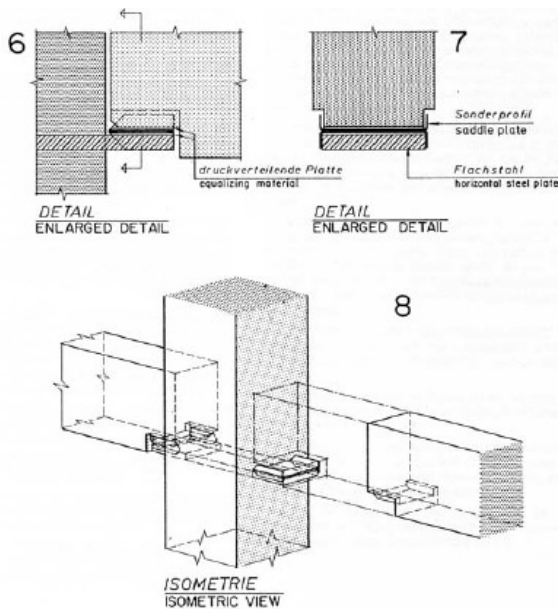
Ligação por consolo metálico (Stupré, 1981)
